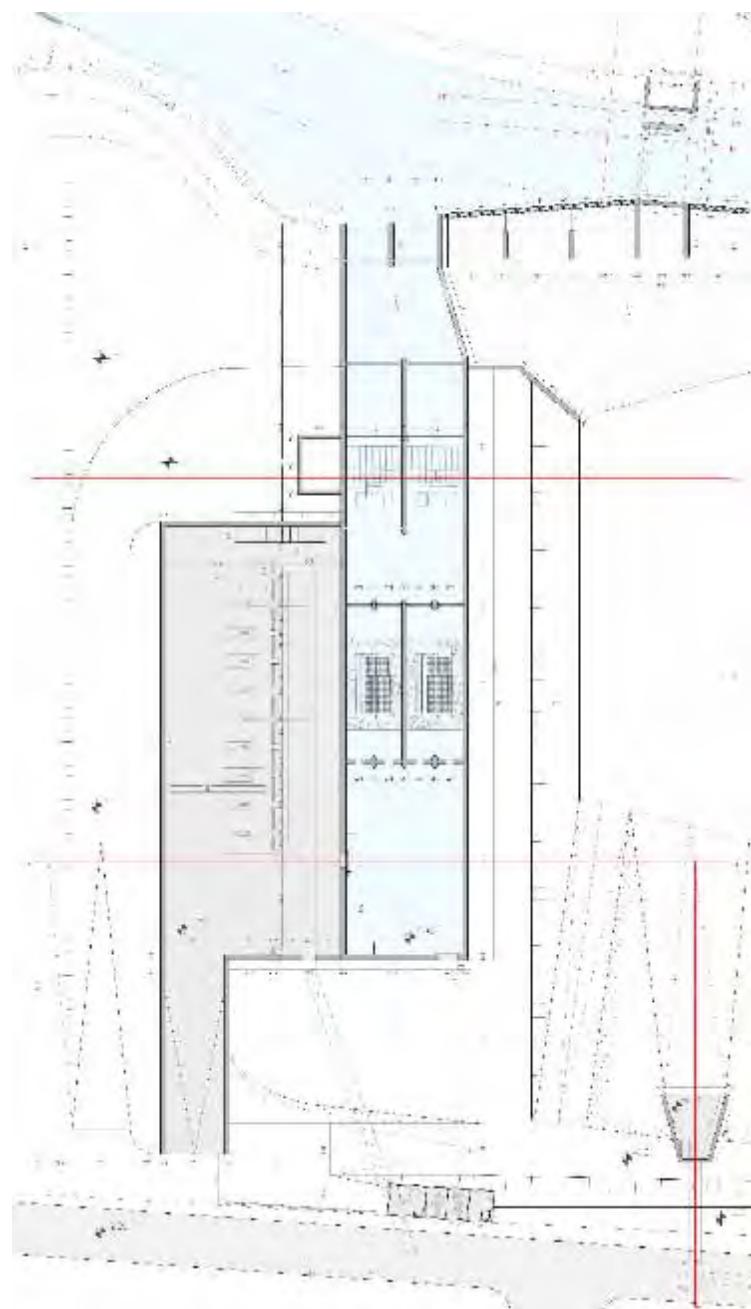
Pianta interrato dell'opera di presa (estratto dal Progetto Definitivo).
